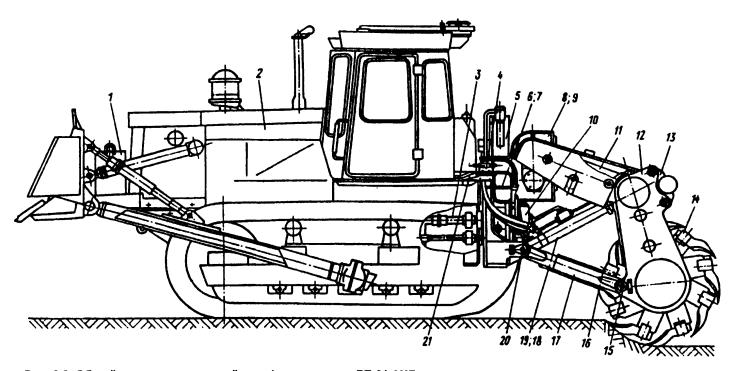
Общий вид машины послойного фрезерования ДП-31 АХЛ:
